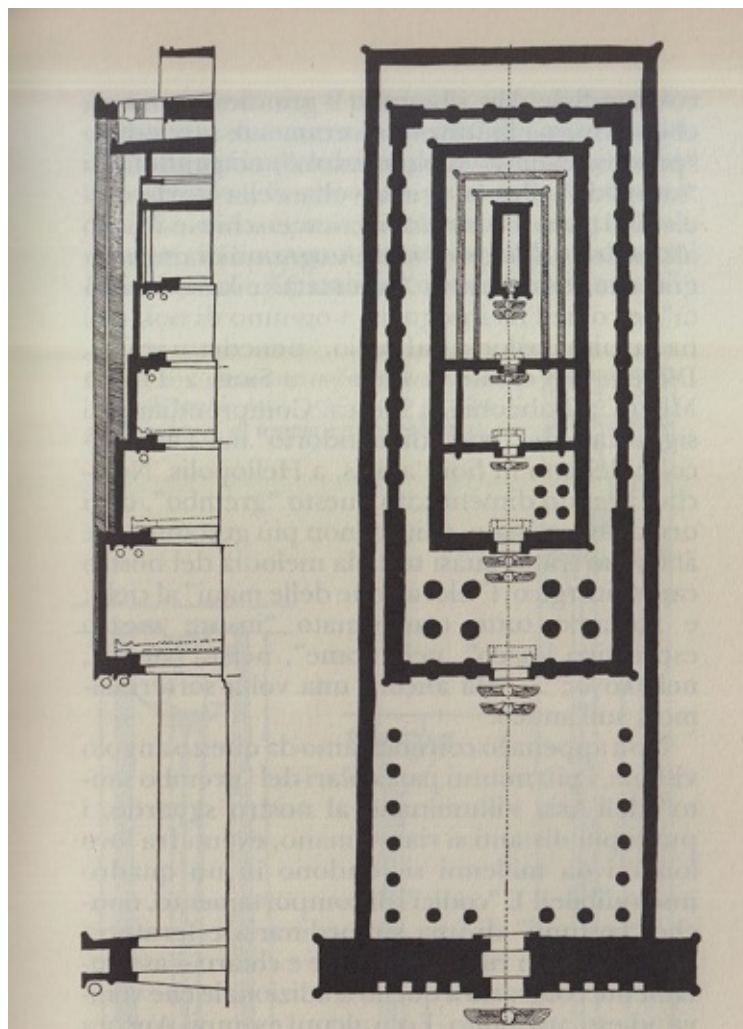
Schema di tempio egizio, visto di fianco. Mentre il soffitto si abbassa progressivamente, il pavimento si va man mano elevando.
